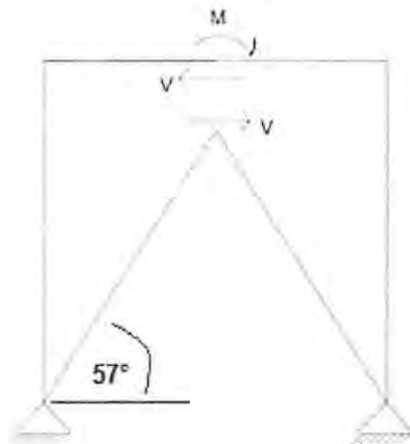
Modelo de fuerzas que ejerce el dispositivo T-adas en la estructura.
